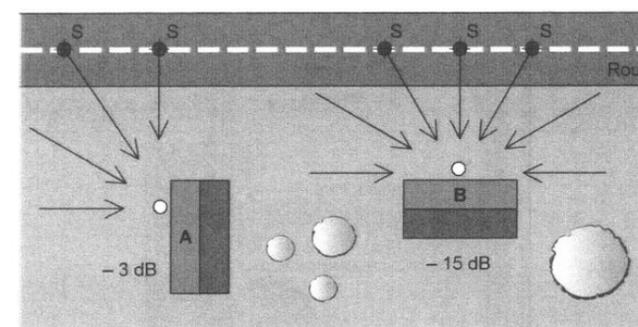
atténuation des niveaux sonores suivant la position des façades (la façade A de l’immeuble voit deux fois moins de bruit que la façade B – La façade arrière du bâtiment B a une atténuation de 15 dB vis-à-vis de la façade exposée)
